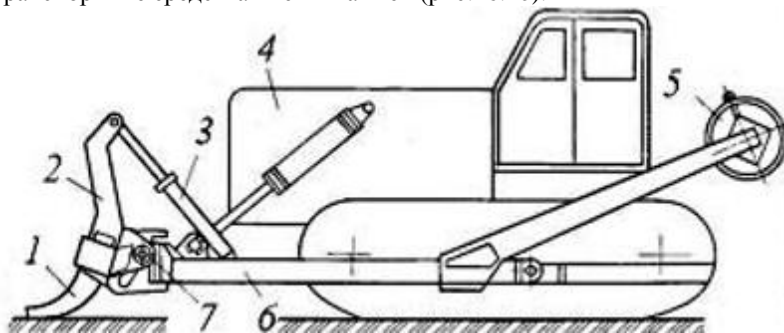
Корчеватель-сборатель: 1 - клык; 2 - отвал; 3 и 4 - гидроцилиндры поворота и подъема; 5 - противовес; 6 - толкающая рама; 7 - кронштейн поворотного устройства.
